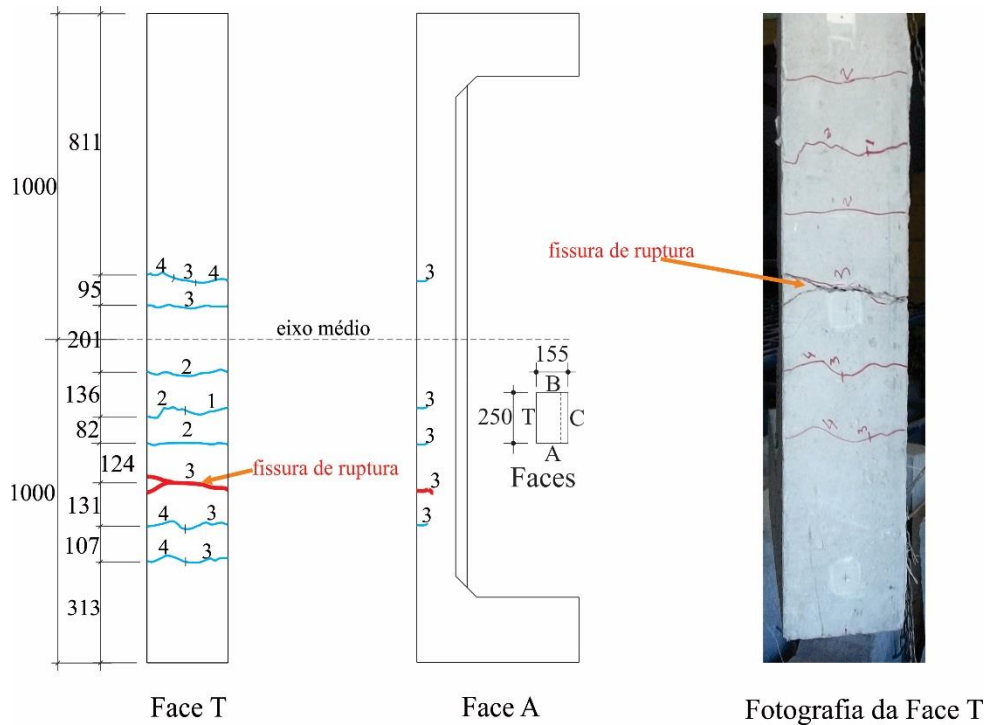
54 - Fissuras nas Faces T e A; Fotografia da face T - pilar PPBA-150-18-Ch
